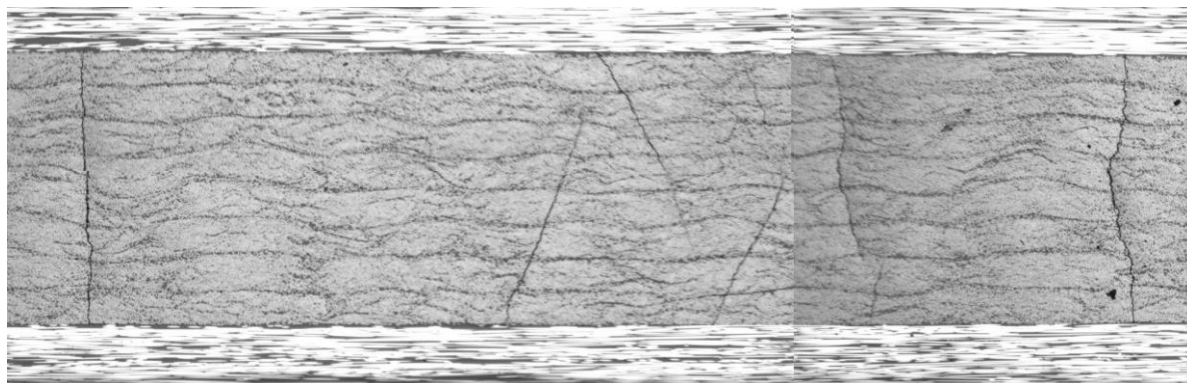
Grietas discontinuas inclinadas entre dos grietas rectas en la muestra 25B.
